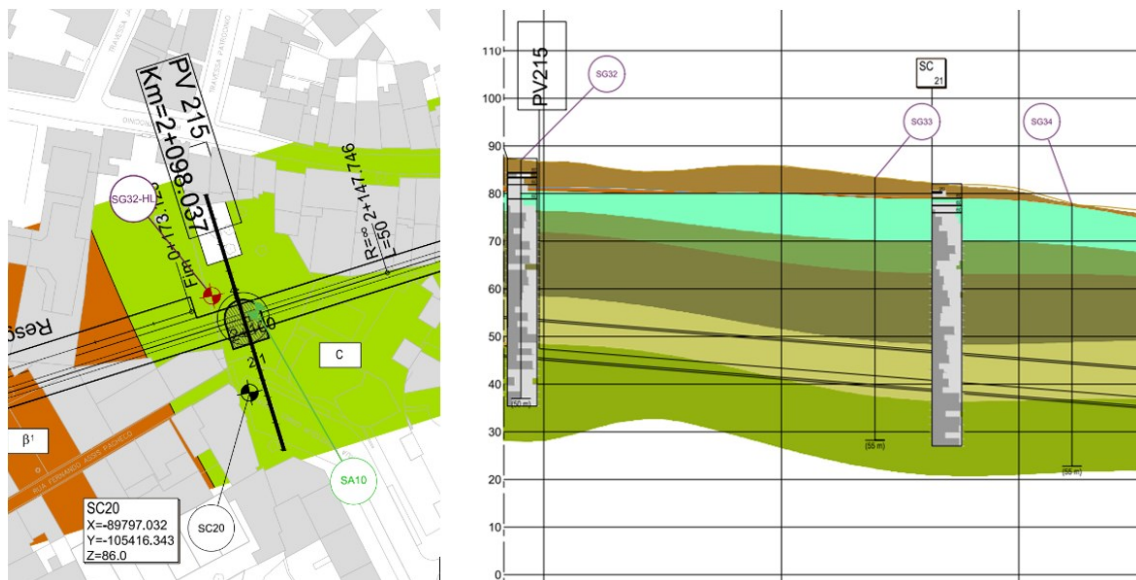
Planta e Perfil longitudinal da Geologia/ Geotecnia na zona do PV115.
